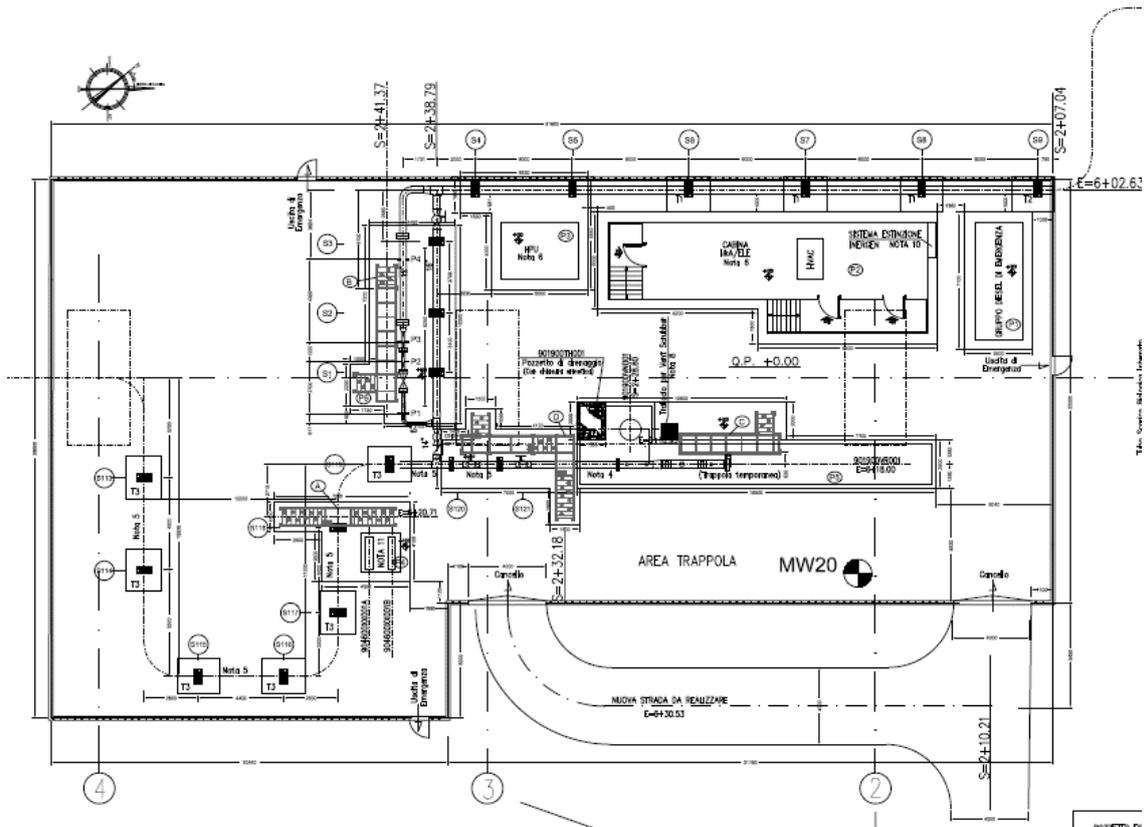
Planimetria area trappola (estratto tratto da 082190DADB10315_EXDE01_01, Eni)
